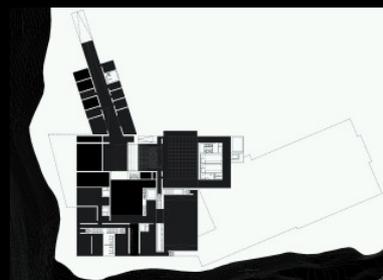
Planta da Casa das Mudas, Calheta (2001-04) – Paulo David
